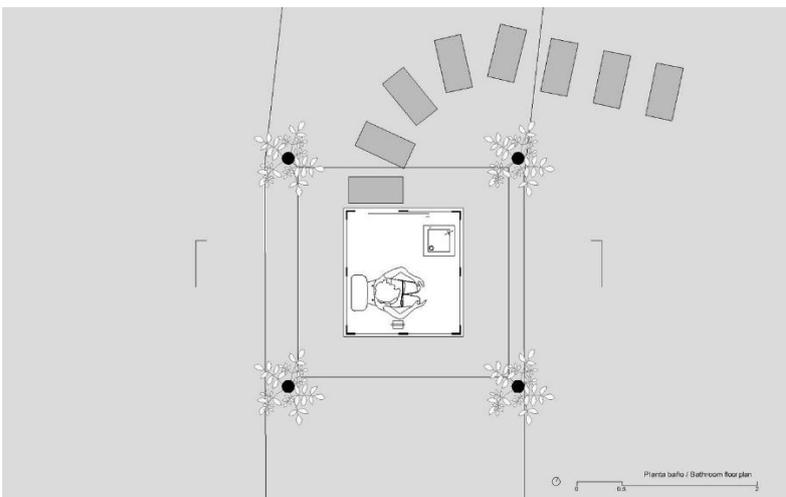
Planta do cômodo sanitário. Desenho do Al Borde, disponível no Archdaily
